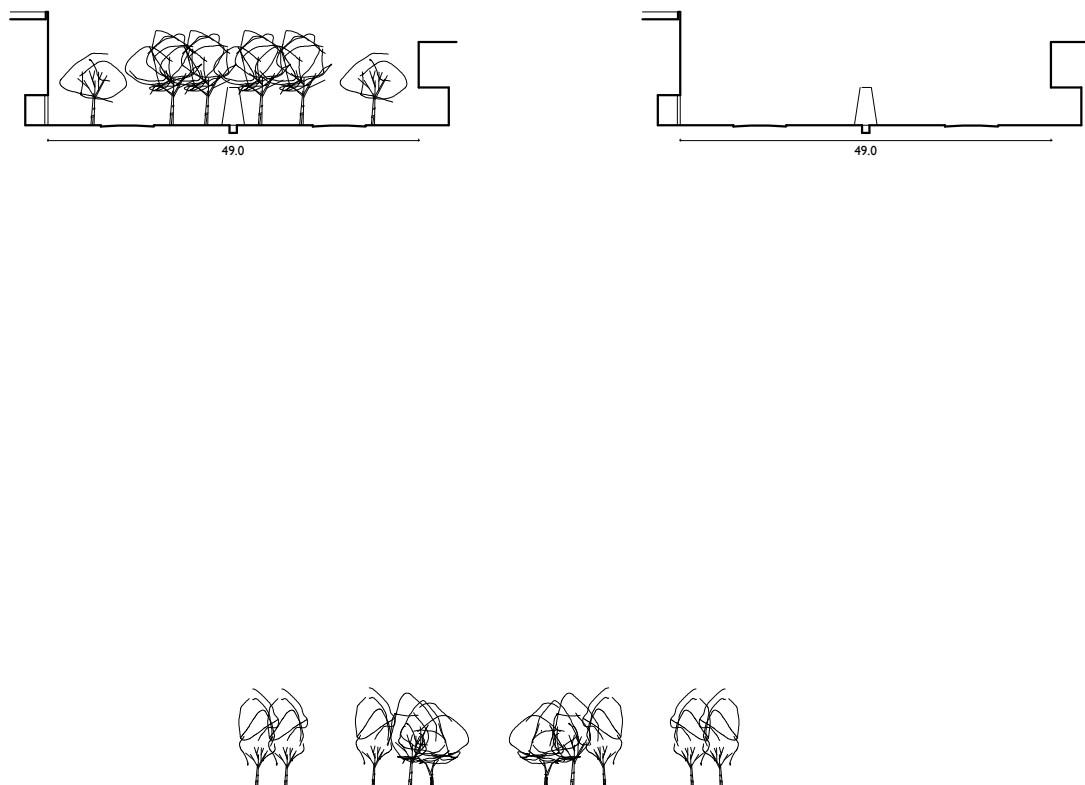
• Síntese sobre a proporção da secção transversal. Secções transversais (1:1.000).
